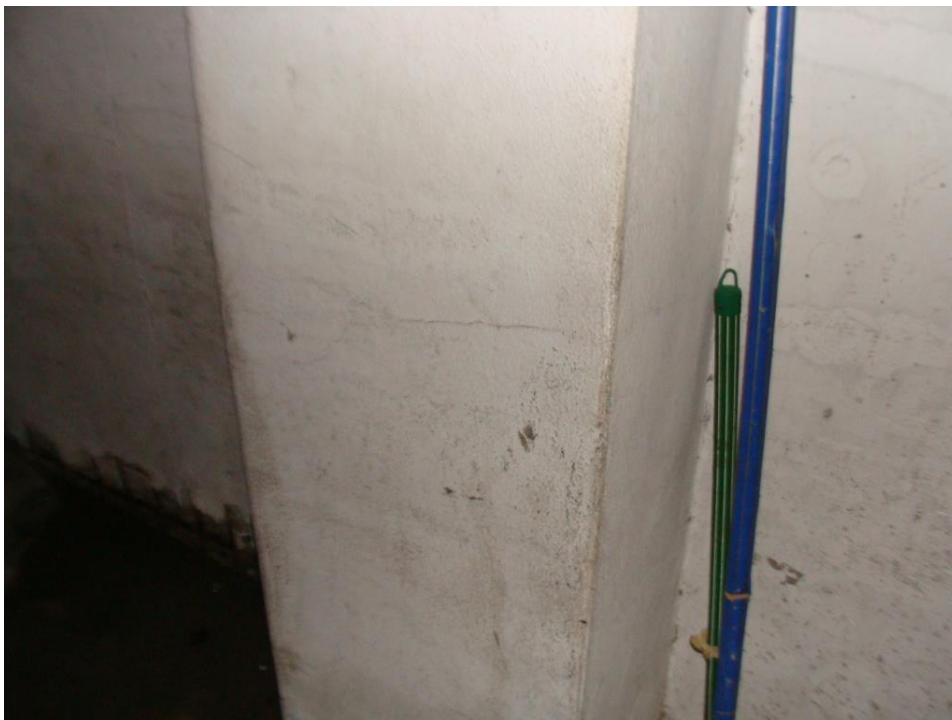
Fissura no pilar P15 (02/03/2021)
